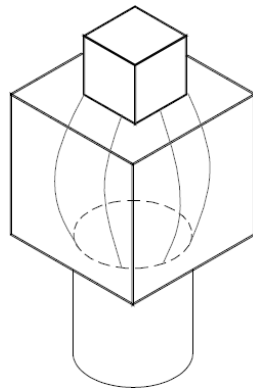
Trajetórias principais de compressão. Fonte: Munhoz, 2004, p. 66.
